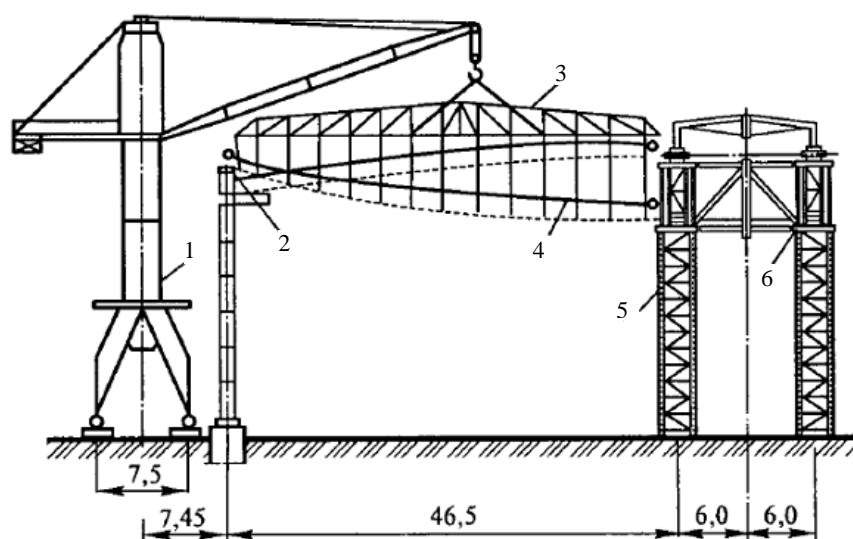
Схема монтажу вантової ферми: 1 – баштовий кран; 2 – зовнішнє збірне залізобетонне кільце; 3 – траверса; 4 – вантова ферма; 5 – тимчасова опора; 6 – центральне кільце
